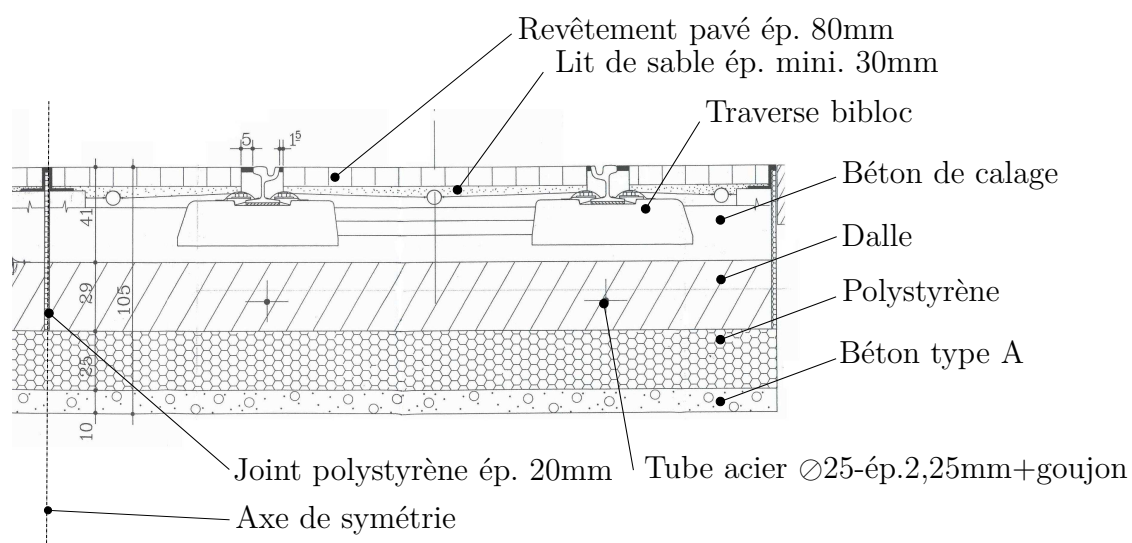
Pose isolante dalle flottante (Libération) - Vue en coupe
